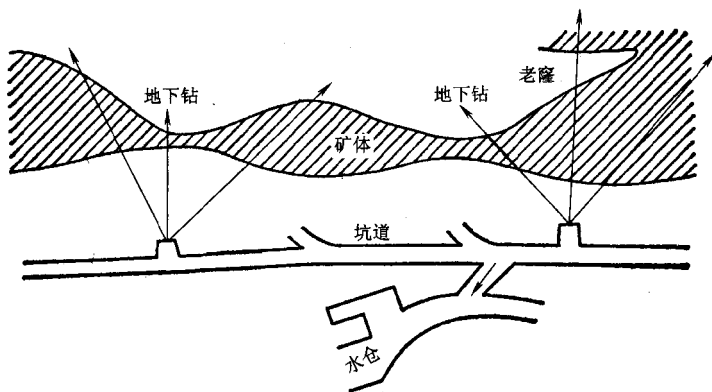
用坑内钻探老窿并疏干其中积水示意平面图
